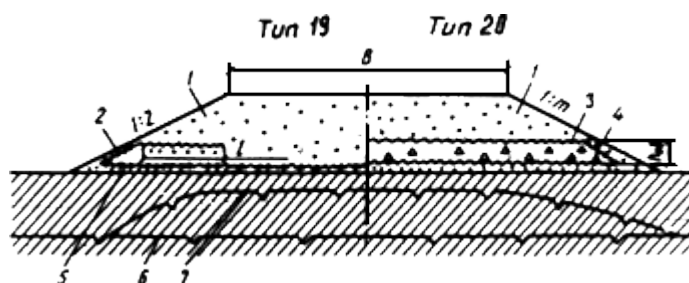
Поперечные профили насыпей с армирующими геотекстильными прослойками: 1 - грунт насыпи; 2 - полуобойма из геотекстиля; 3 - обойма из геотекстиля; 4 - грунт, в том числе твердомерзлый в нижней части насыпи; 5 - выравнивающий песчаный слой толщиной 0,2-0,3 м; 6 - ВГВМ в естественных условиях; 7 - то же, после постройки насыпи
